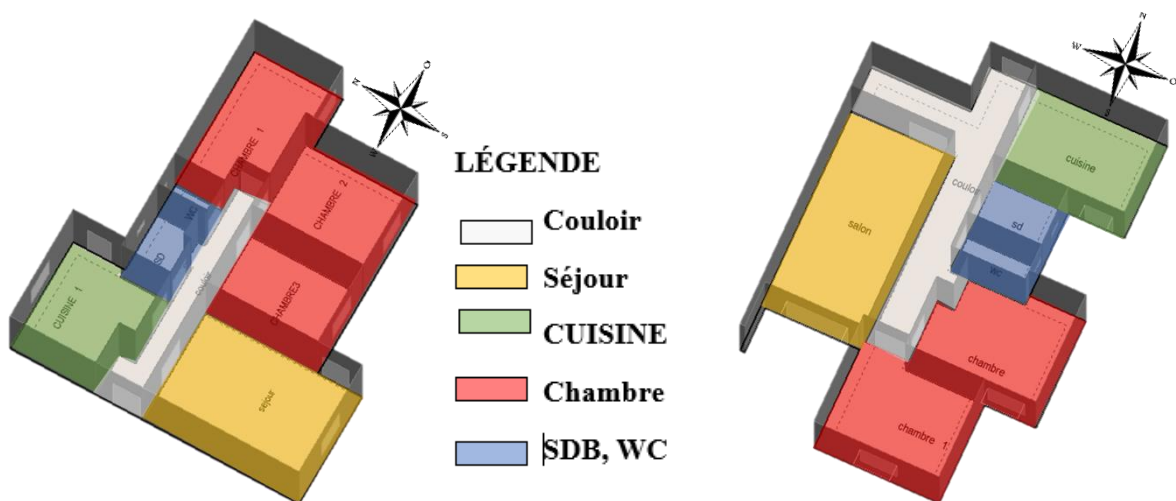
Vue en plan de projet, dessinée sous DesignBuilder
